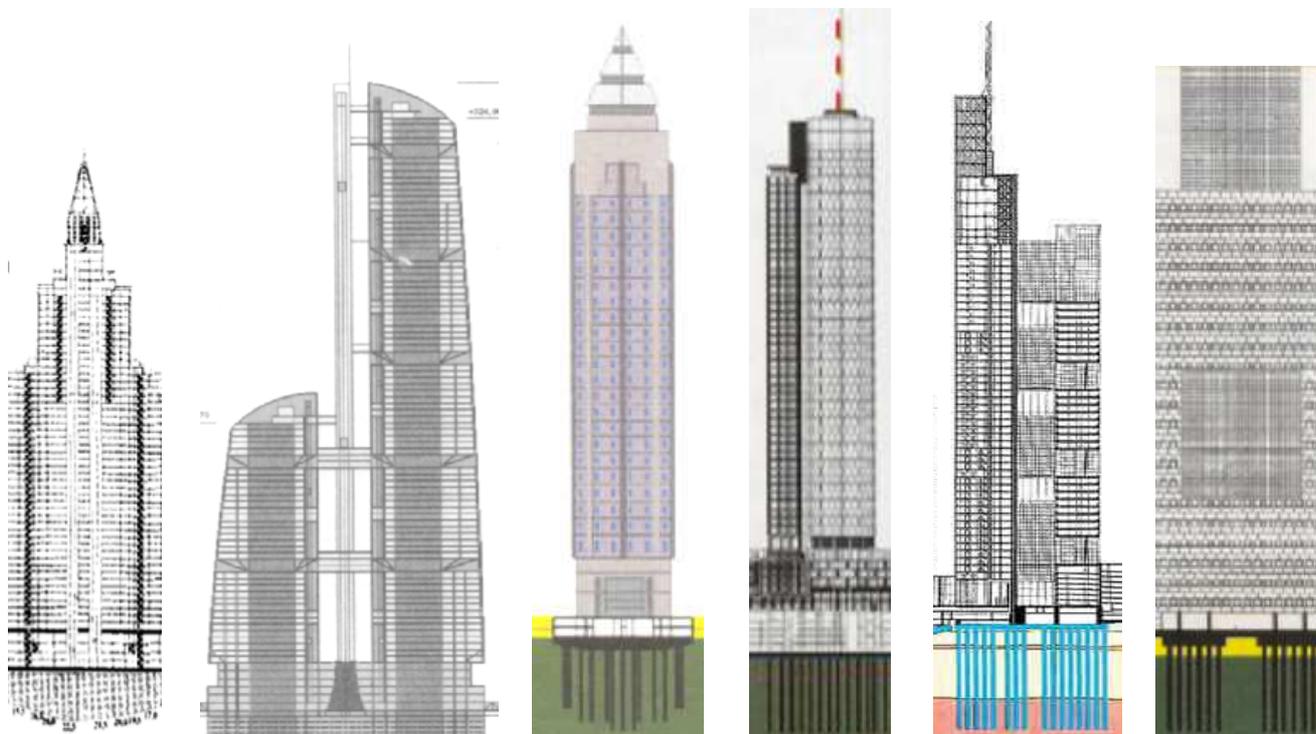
Схемы совмещенных фасадов и разрезов высотных зданий
